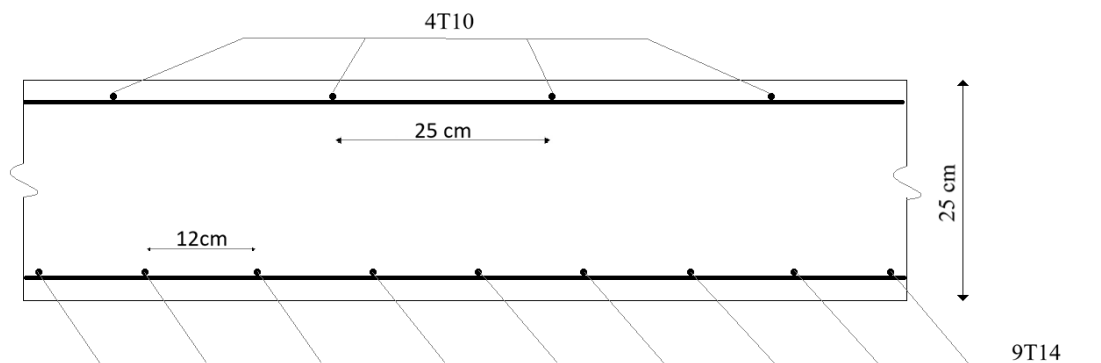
schéma de Ferrailage de l'hourdis dans le sens transversal
